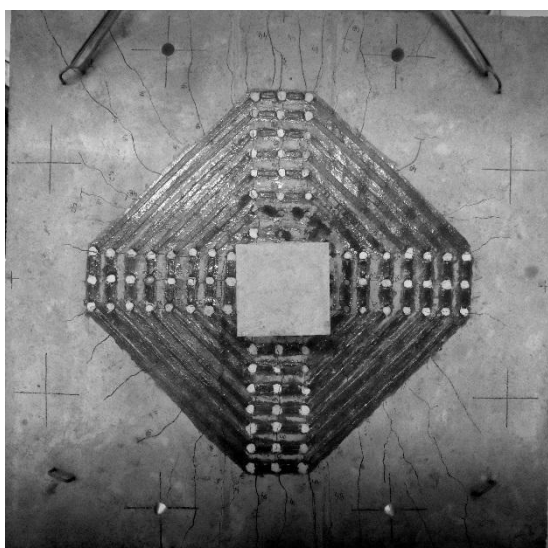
Padrão de Fissuração - LC-S2-8
